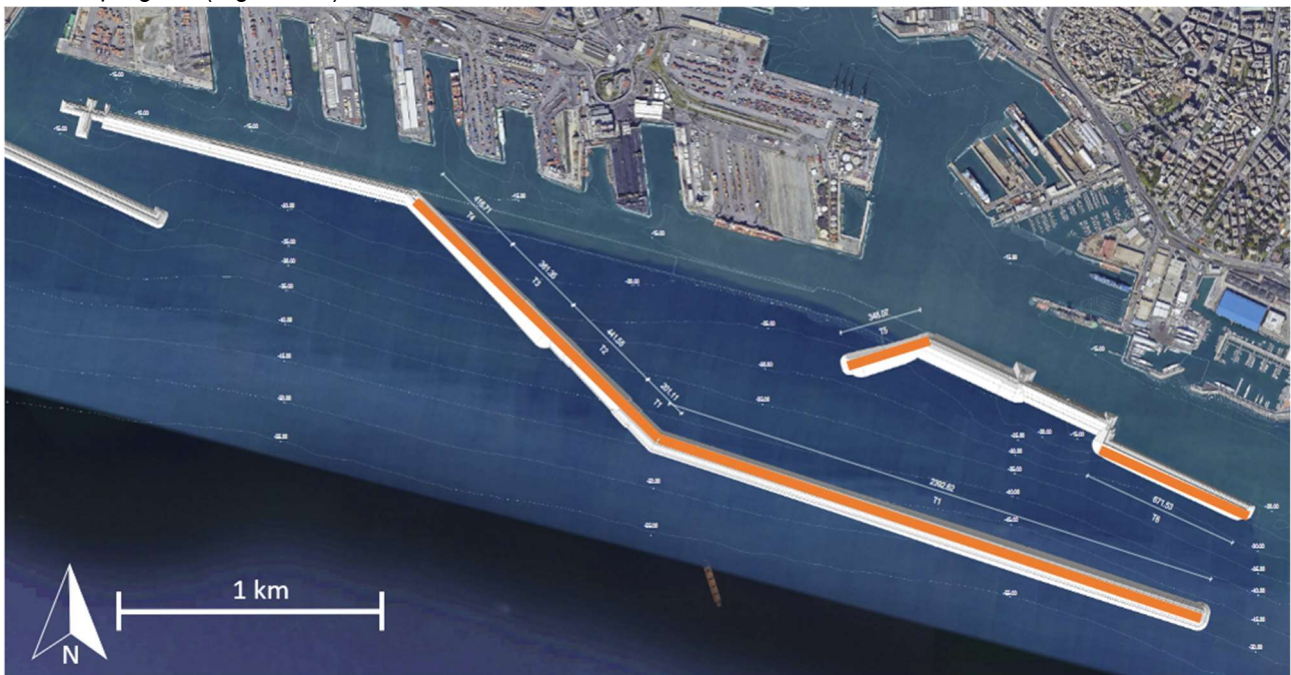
Planimetria di progetto - In arancione le aree interessate dalle attività previste nella Fase A
